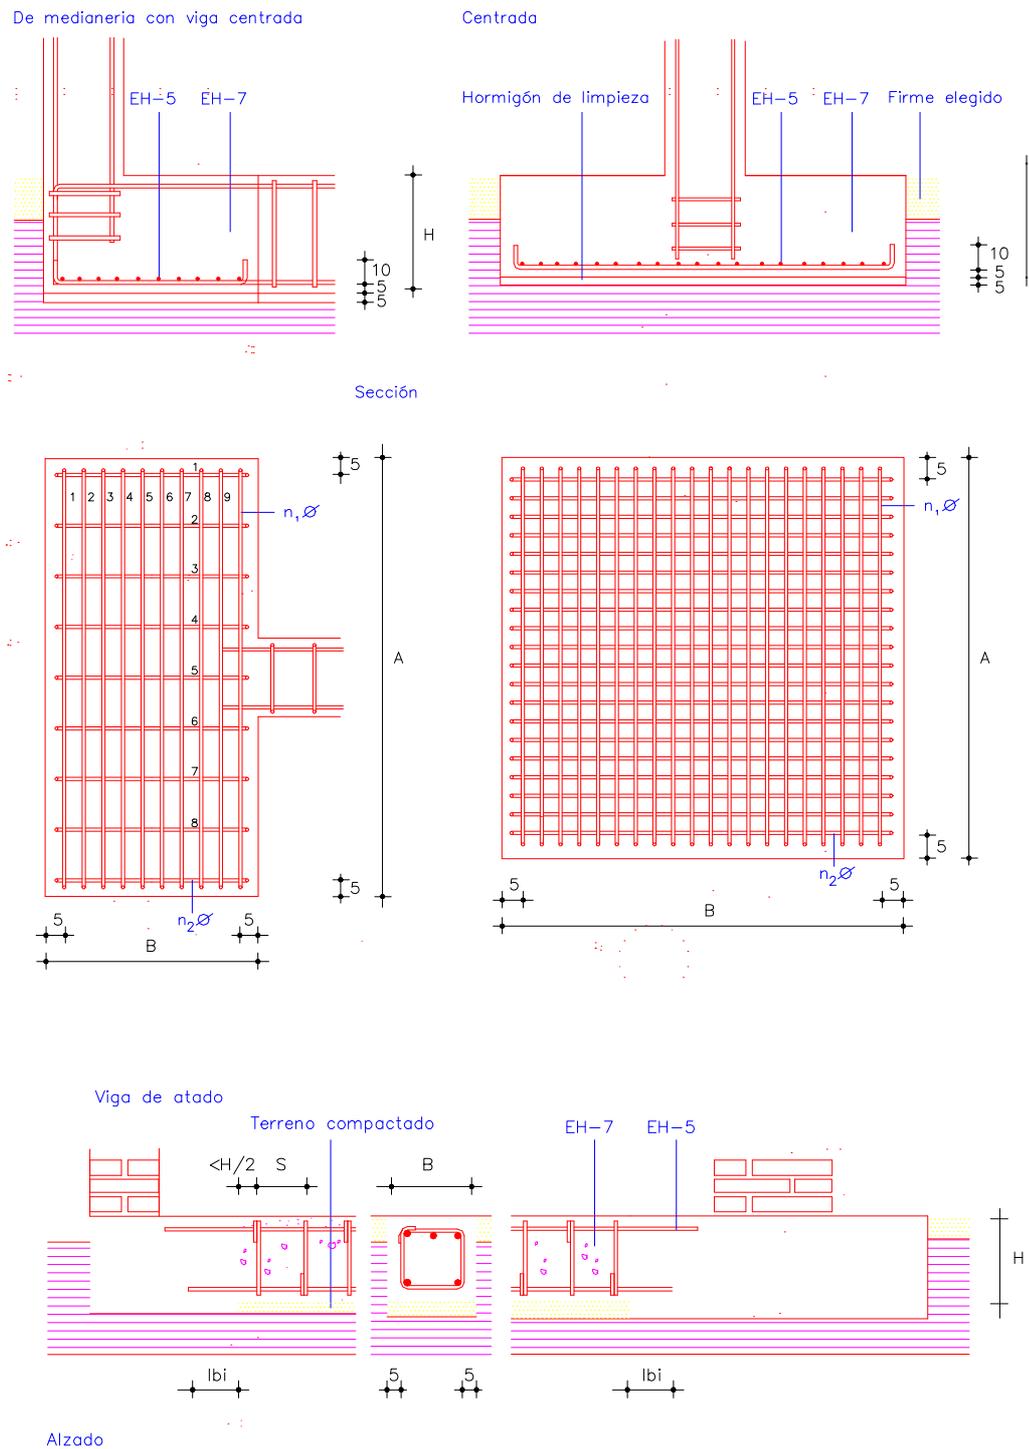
Zapata centrada, de medianería y viga atado según NTE
